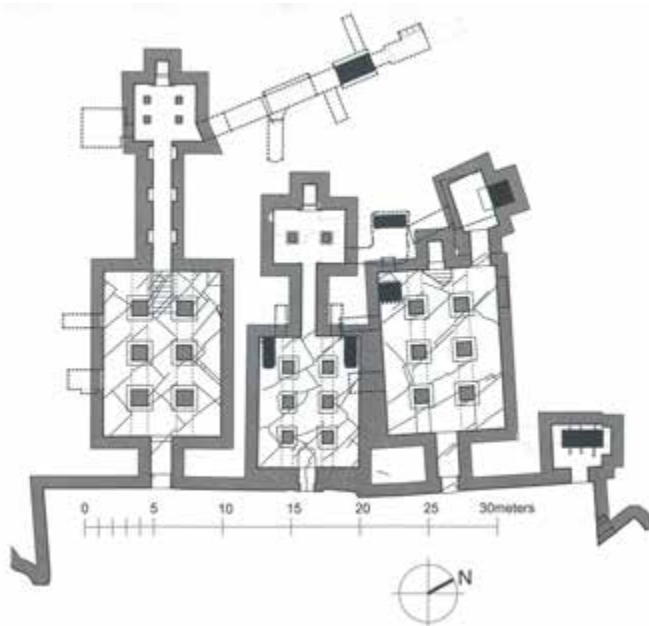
Planta de las tumbas QH31, QH32, QH33 y QH34. Grietas naturales de la roca en el techo de las salas hipóstilas. © Proyecto Qubbet el-Hawa (Juan Antonio Martínez Hermoso).
